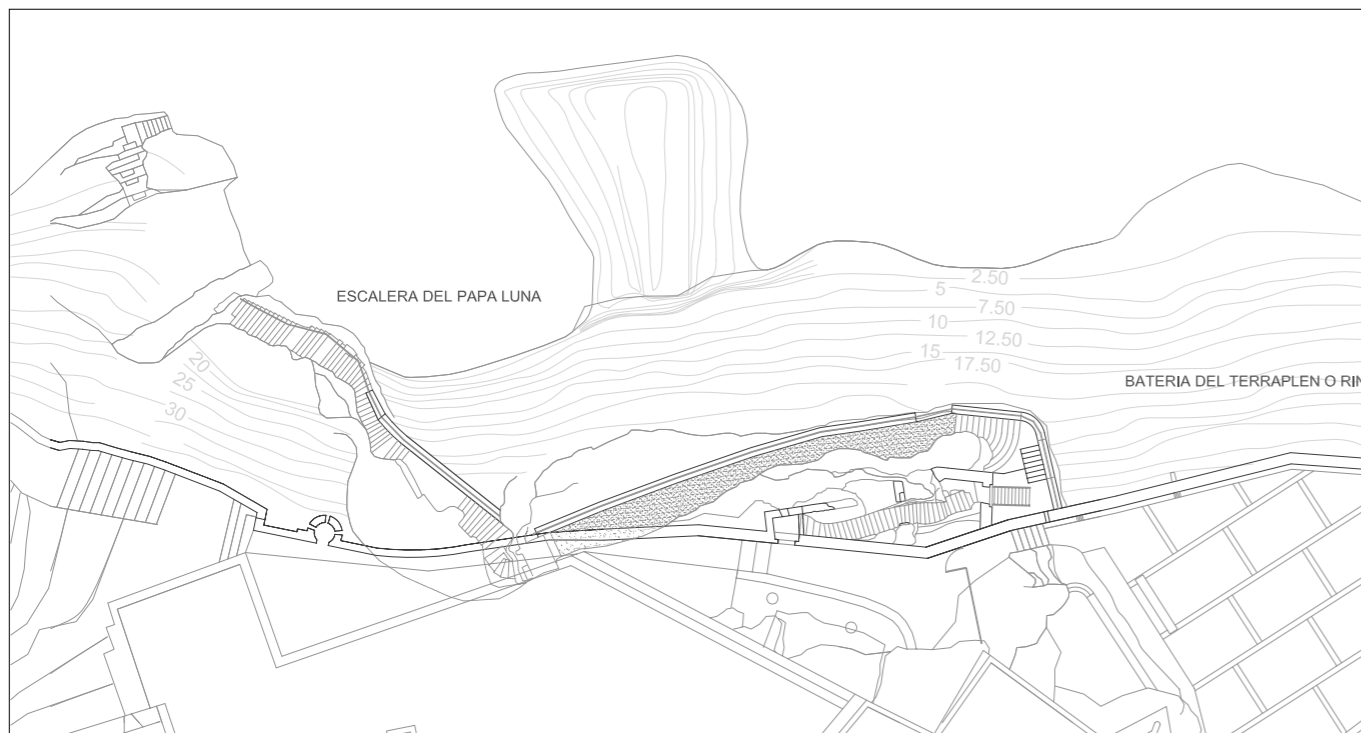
Planta de la escalera del Papa Luna. Proyecto de restauración del Castillo de Peñíscola. Fortificaciones del este. (MJB 2000).
